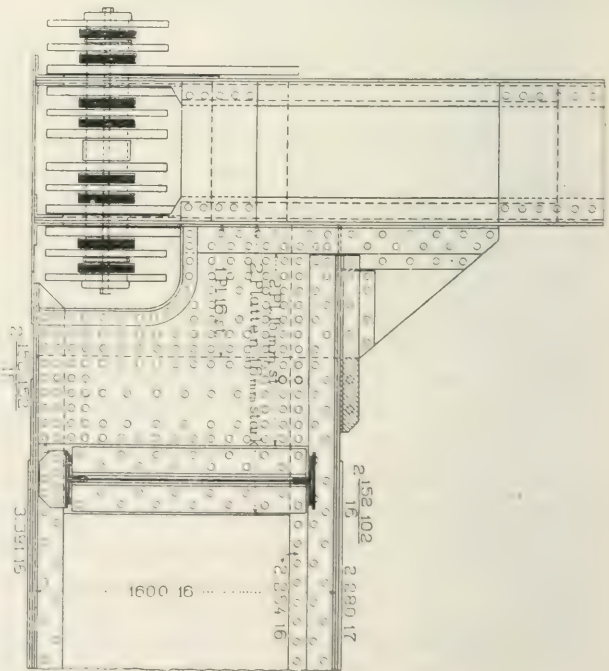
Untergurtnoten einer amerikanischen Fachwerksbrücke.
